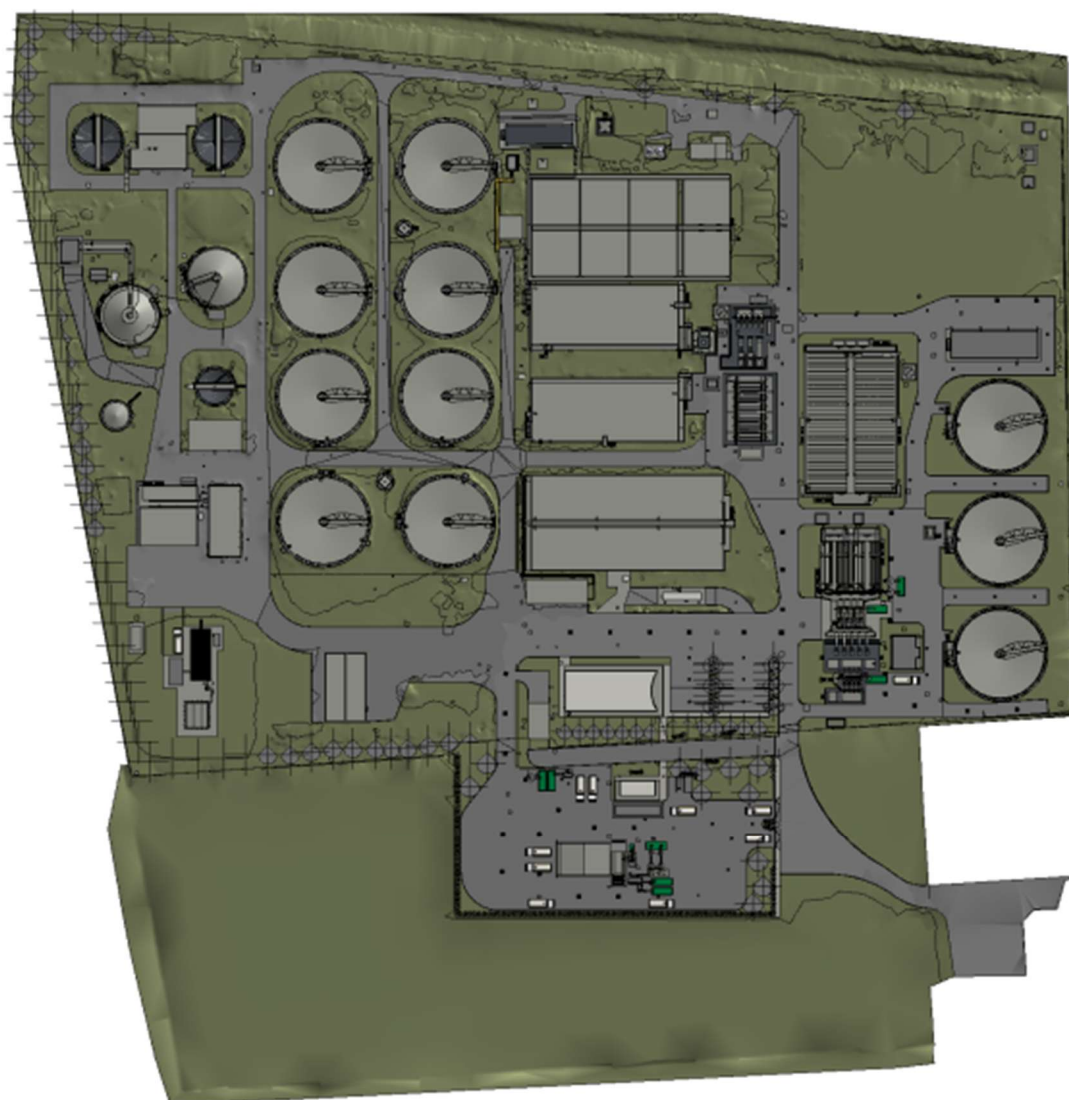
Layout stato di progetto impianto di depurazione di Ravenna
